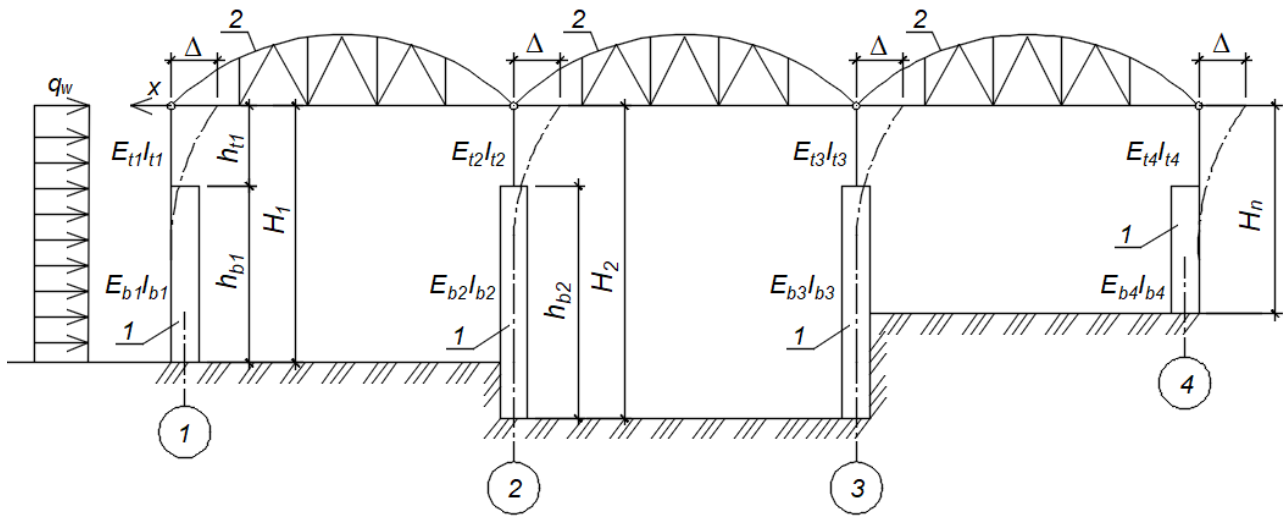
Схема поперечної рами в розрахунках стін будівлі з пружною конструктивною системою: 1 – защемлені на рівні підлоги будівлі стояки (стіни і стовпи); 2 – ригелі (перекрыття і покриття) – жорсткі розпірки, шарнірно з’єднані зі стояками; h_{ti} – висота надкранової частини стіни; h_{bi} – висота підкранової частини стіни; H_i – висота всієї стіни; E – модуль пружності кладки; I – момент інерції перерізу стояка; q_w – тиск вітру; Δ – переміщення пружної опори під навантаженням
